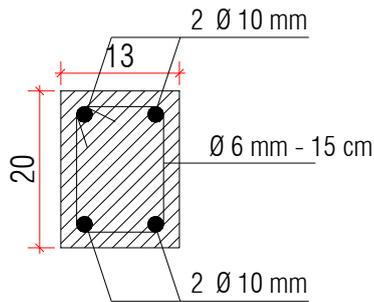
Detail Balok Latei / Balok Pinggang 13/15 cm
